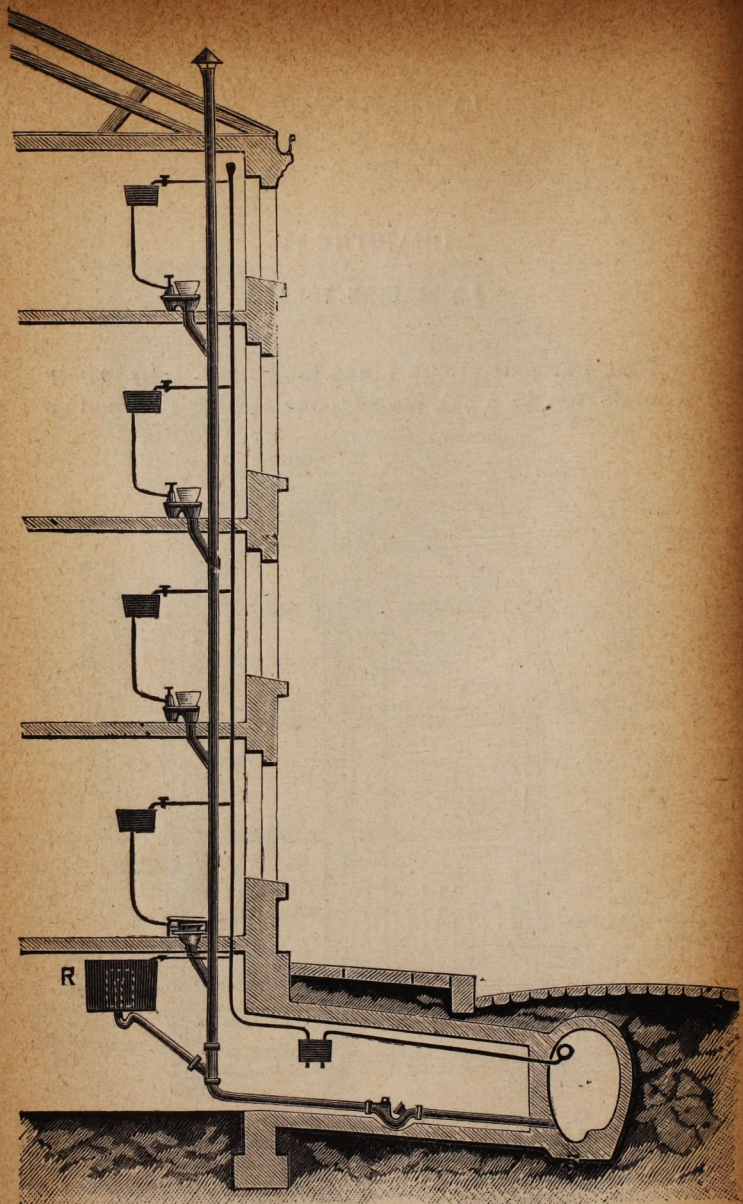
Installation du tout à l'égout dans une maison ancienne, en conservant les appareils existants, suivant les règlements de 1894 et 1896 (installation faite par la maison Flicoteaux).
